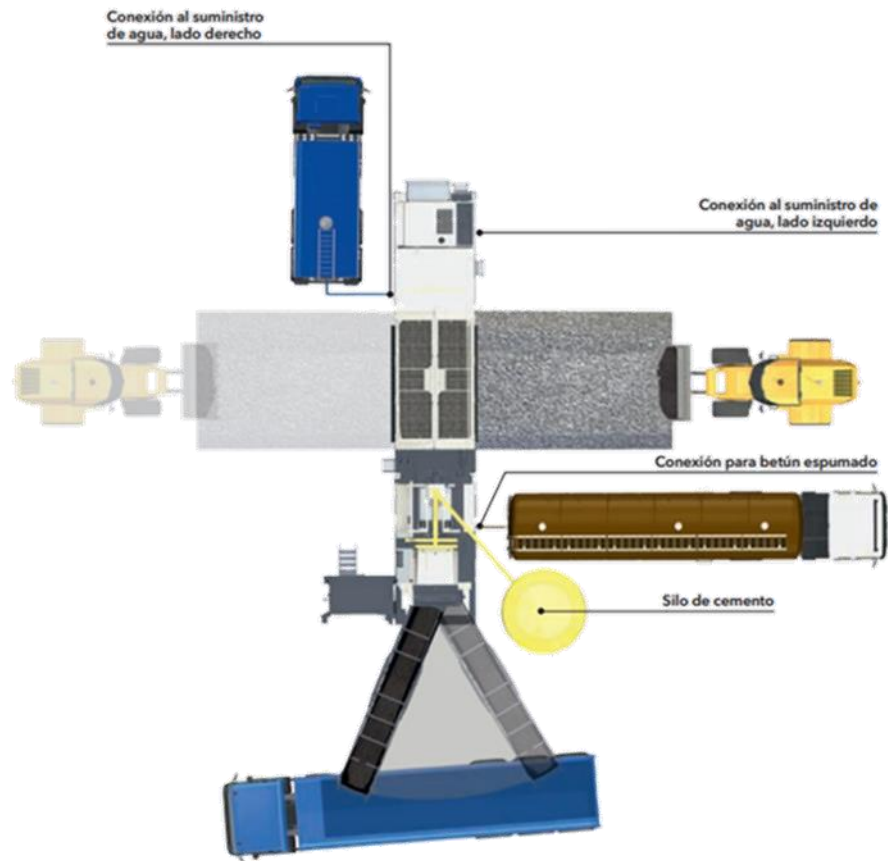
Planta de mezclado en sitio y su esquema de producción de asfalto espumado. Fuente Wirtgen maquinaria.
